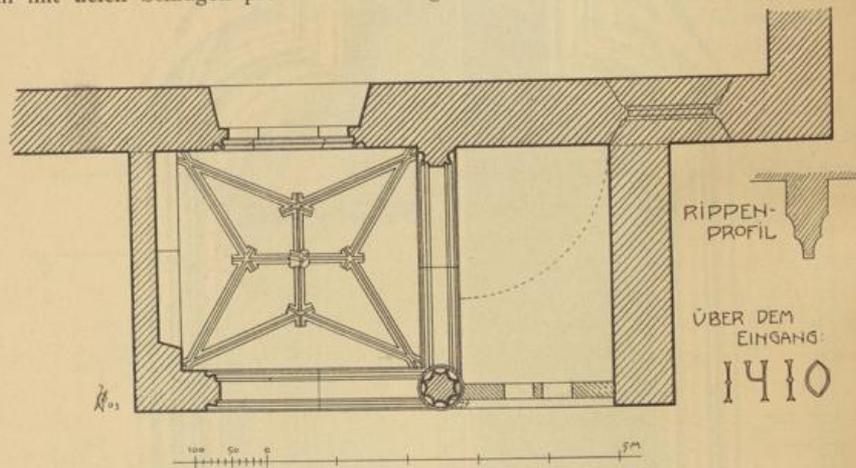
Kilchzarten. Kirche. Grundriss der Vorhalle.
